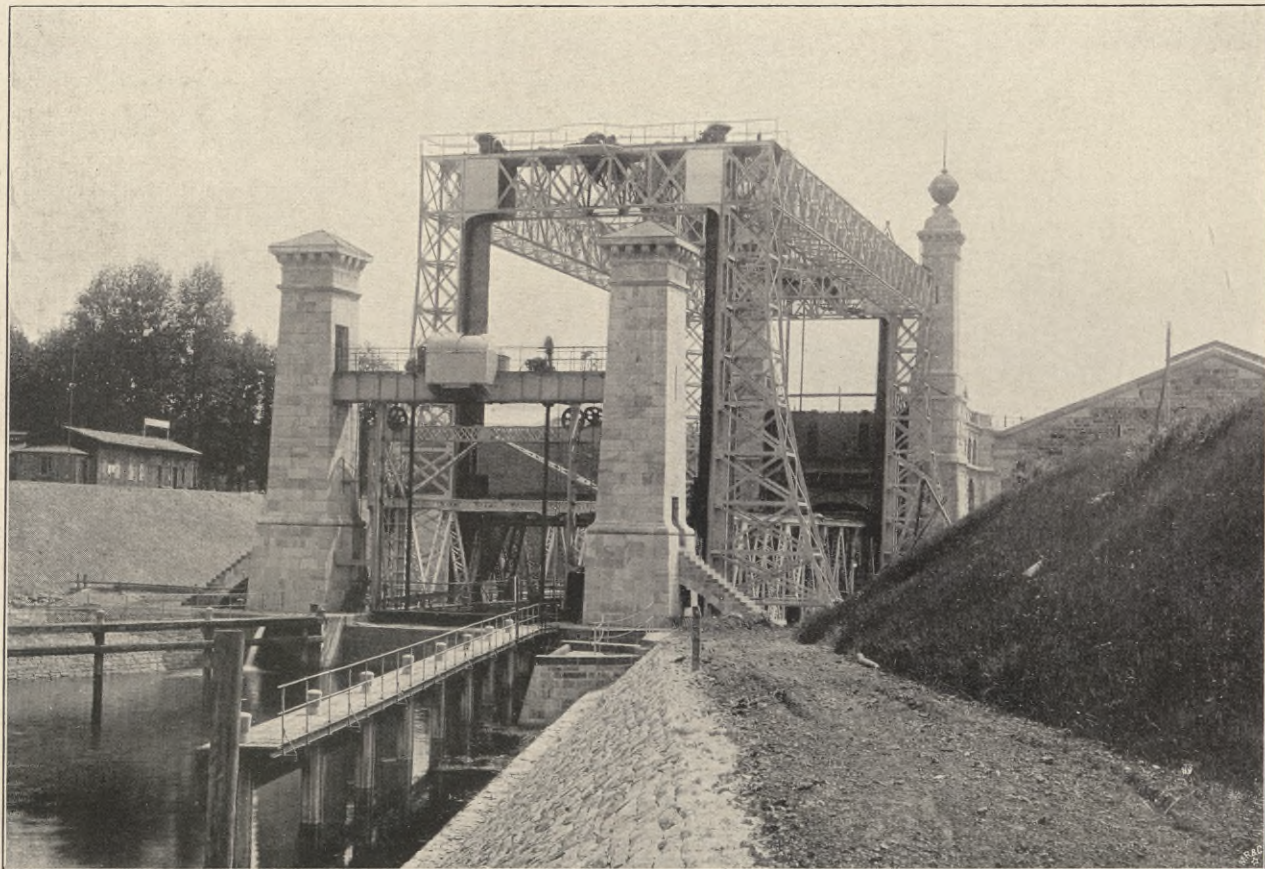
EISENKONSTRUKTIONEN ZUMSCHIFFSHEBEWERK IN HENRICHENBURG,
